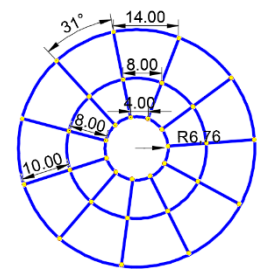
PLAN DE STRUCTURE DE L'EQUIPEMENT DE SERVICE
